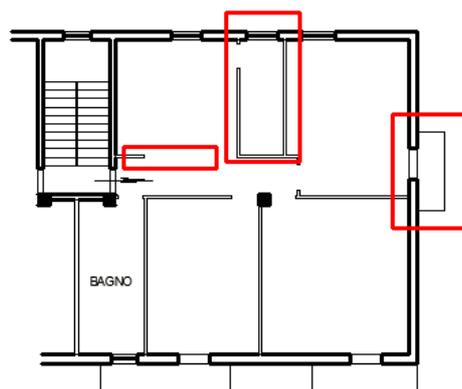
Confronto con indicazione delle difformità tra stato reale e planimetria catastale
